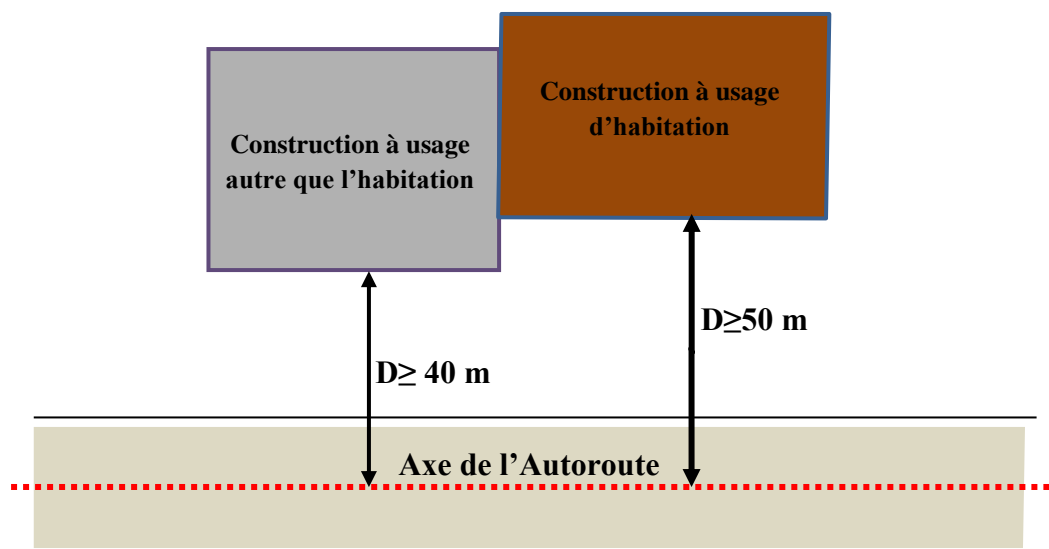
Vue en Plan d finissant le recul ou la servitude d'une construction par rapport   une autoroute.
